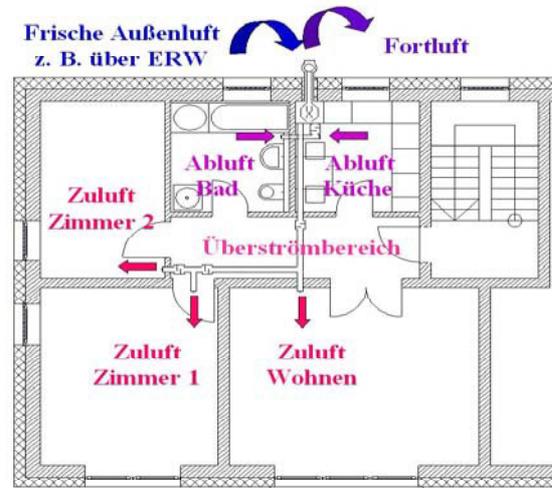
Zu-/Abluftanlage mit WRG (Grundriss)
